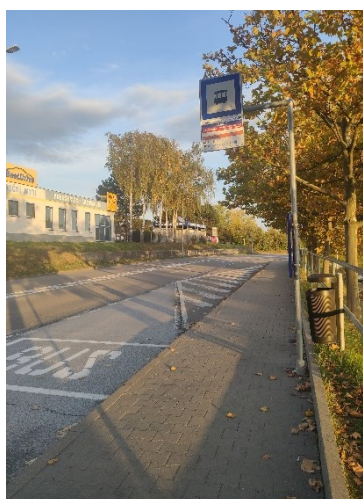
Návrh úpravy přechodu u Kauflandu (pohled 2)
